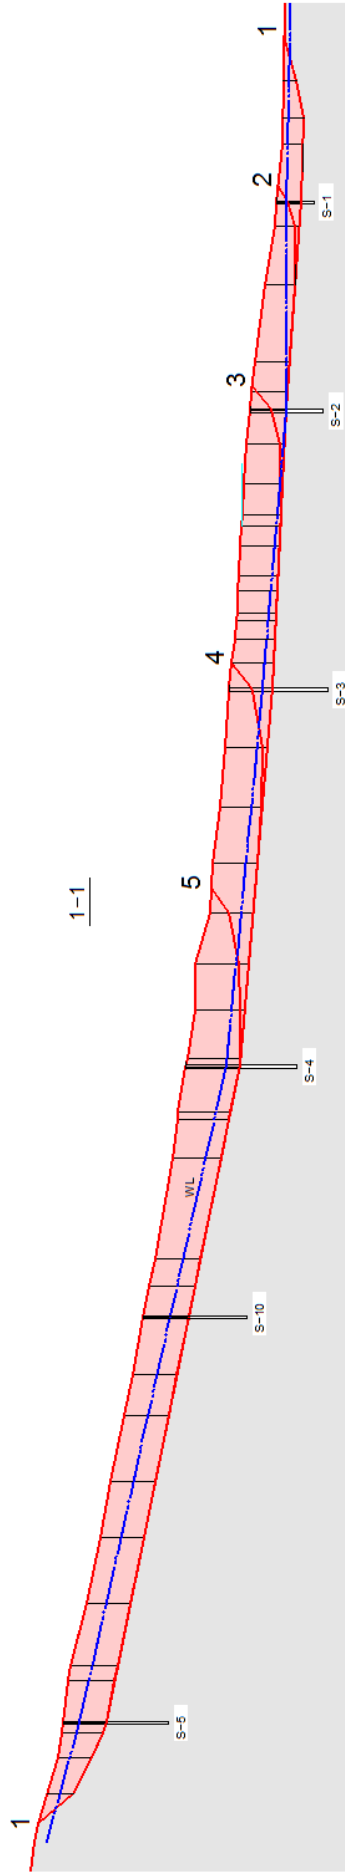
Schema de calcul pentru determinarea stabilității versantului pe terenul alunecător nr.4 din satul Trușeni
